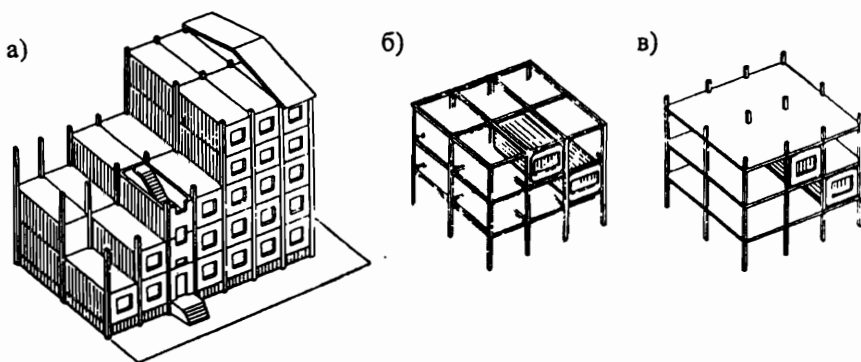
Каркасно-блочная конструктивная схема зданий: а – со стоечно-безригельным каркасом; б – с полным стоечно-ригельным каркасом; в – со стоечно-безригельным каркасом и сплошным перекрытием
